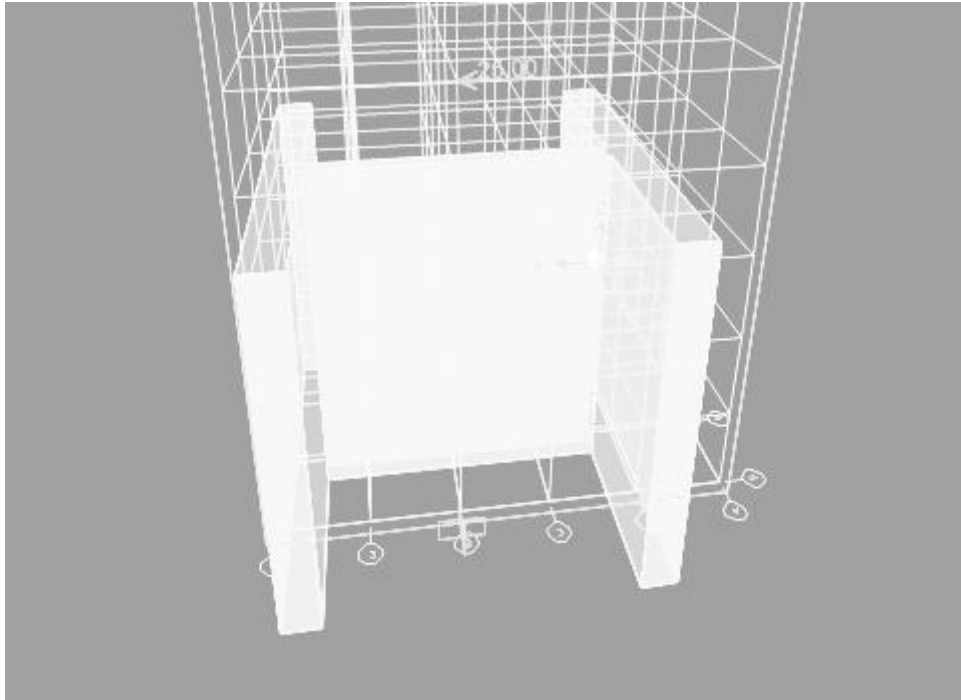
6: Modelación de viga apoyo fijo en SAP 2000.
